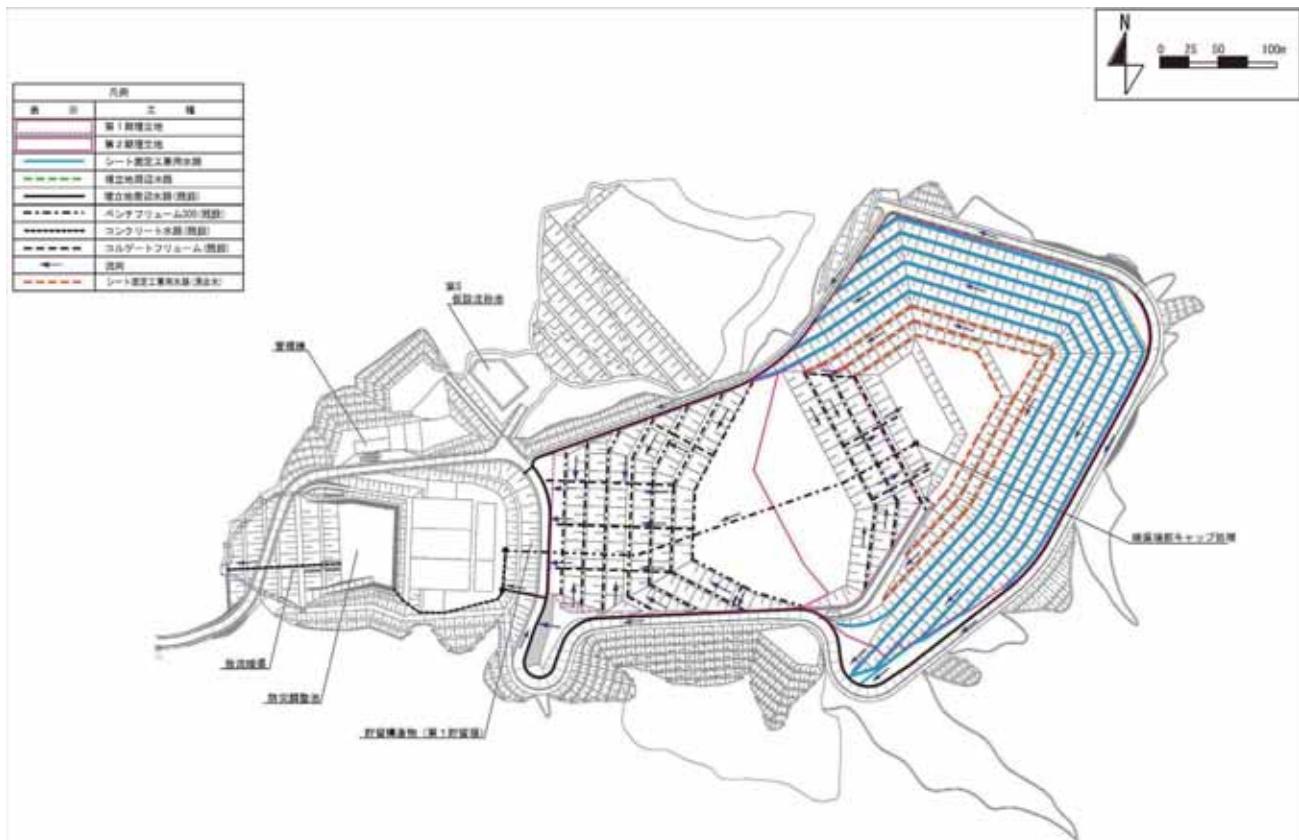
雨水集排水施設配置図 埋立開始時（第2期整備）
